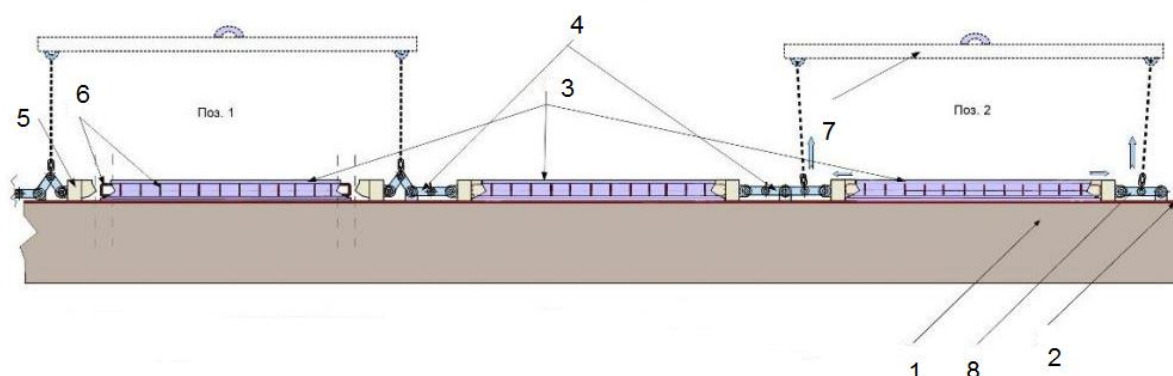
Механизированное открывание бортов формы стендовой линии «СЛ-3V» для формовки плит перекрытия строительной системы «КУБ-3V».
